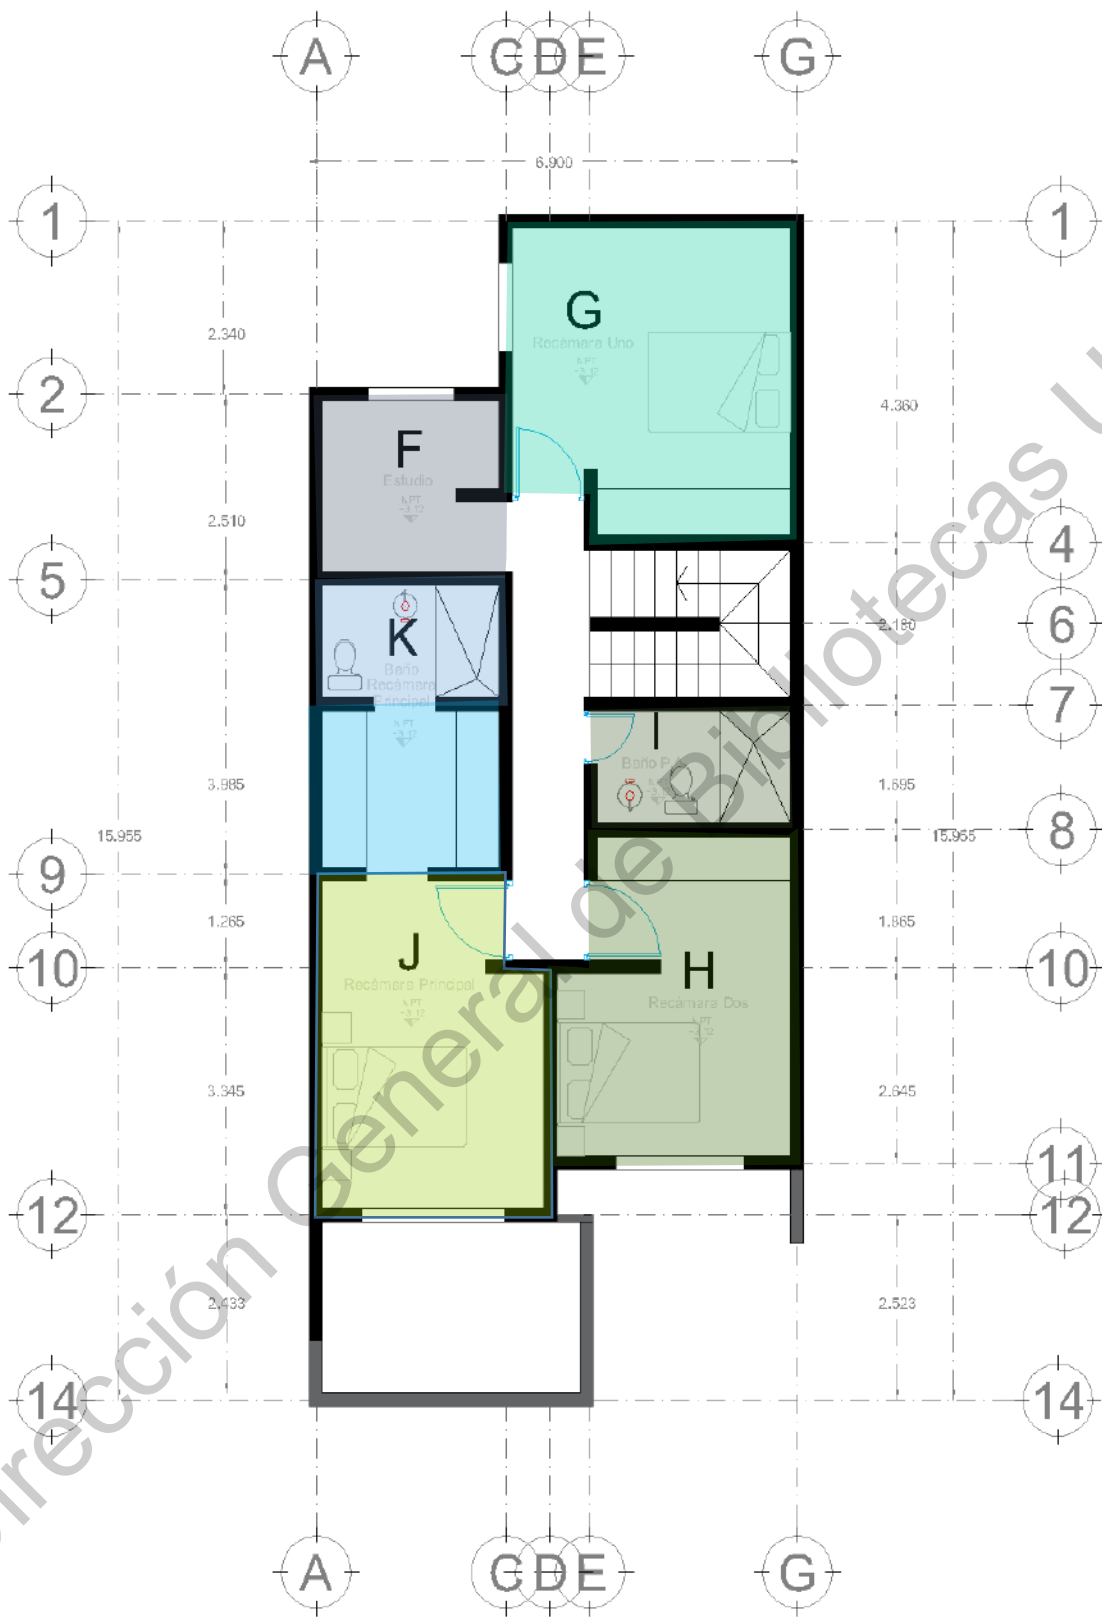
Planta Arquitectónica Alta. Casa Ixtlán. Zonificación Ecotect
